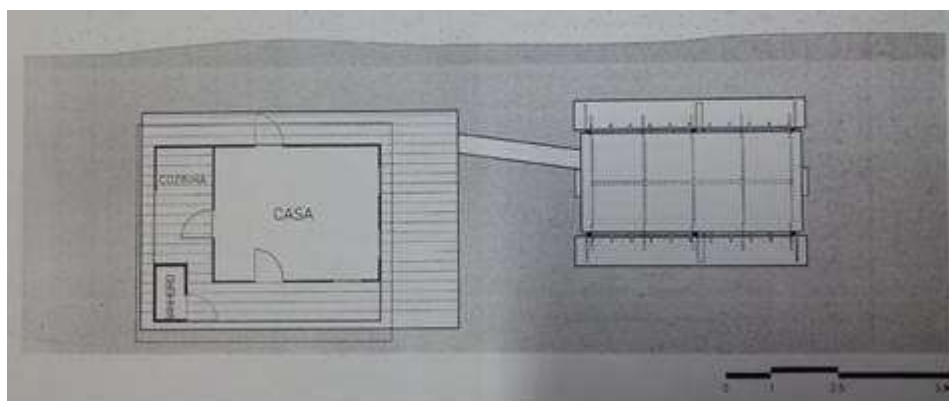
Planta modelo de uma casa flutuante com plataforma ao redor a -
